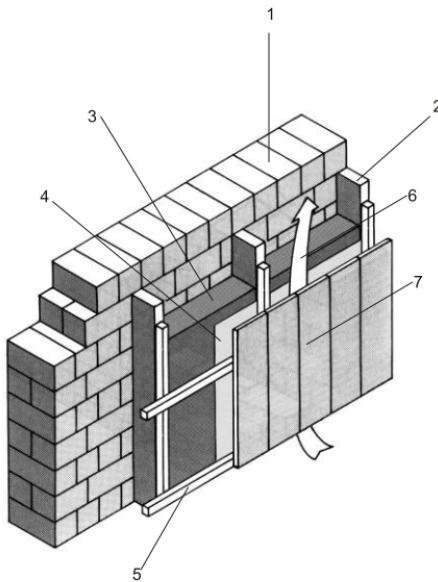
Навесной фасад с системой выходных вентиляционных каналов: 1 — наружная стена; 2 — вертикальные деревянные рейки; 3 — теплоизоляционные плиты; 4 — диффузионно-проницаемый лист; 5 — деревянная обрешетка; 6 — вентилируемый воздушный зазор; 7 — наружная деревянная обшивка
